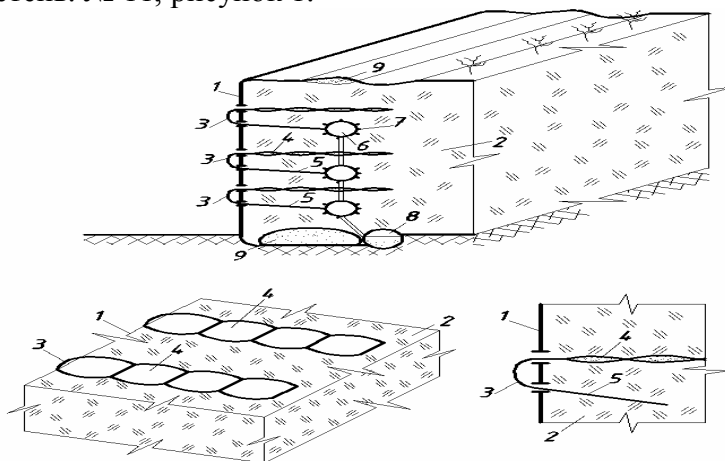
Грунтоармированное подпорное сооружение (1 – лицевая (ограждающая) стенка; 2 – насыпной грунт; 3 – гибкие связи; 4 – наклонные ленты; 5 – гофрированные ленты; 6 – оболочка – дрены; 7 - специальные отверстия; 8 – дренажные системы; 9 – анкерный блок выполненной
